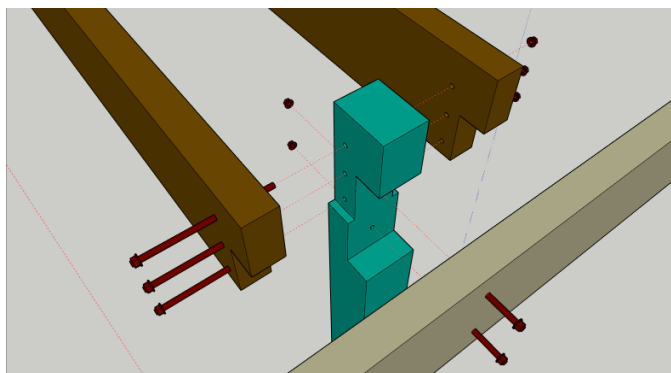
Узел крепления к колонне обвязочных балок и балок покрытия
